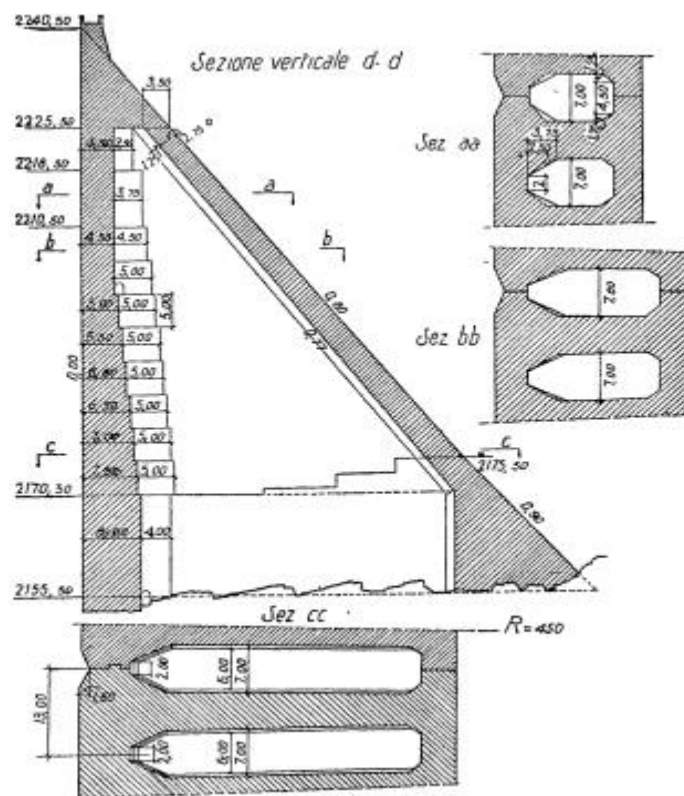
Coupe transversale et horizontale du barrage évidé de la Dixence Suisse (Carrère, 1996, Schleiss and Pougatsch, 2011)
